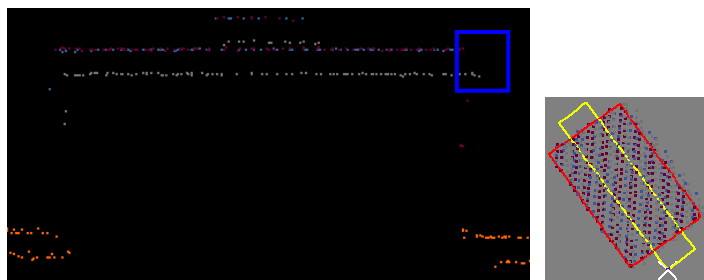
剖面檢視 Building1 東南側邊緣點雲確實有偏移
